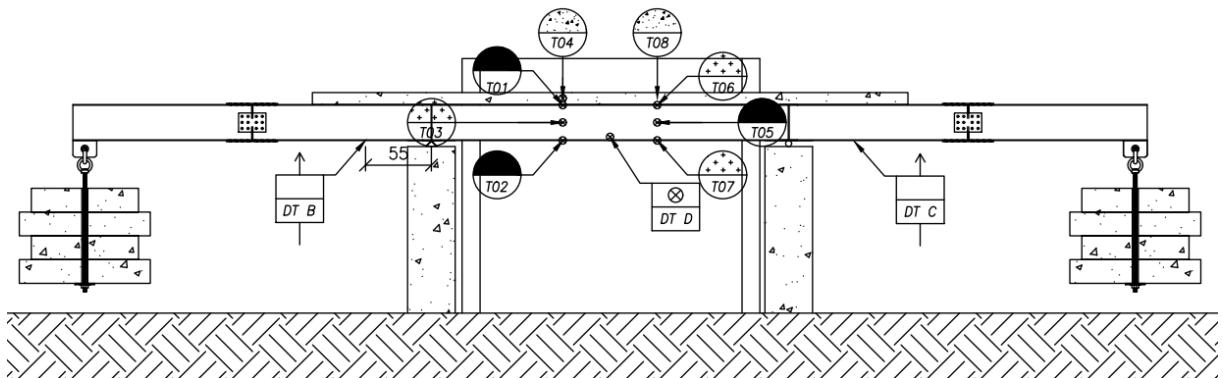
Posicionamento dos termopares soldados e LVDTs nos ensaios das vigas V2, V3 e V4. Dimensões em cm.
